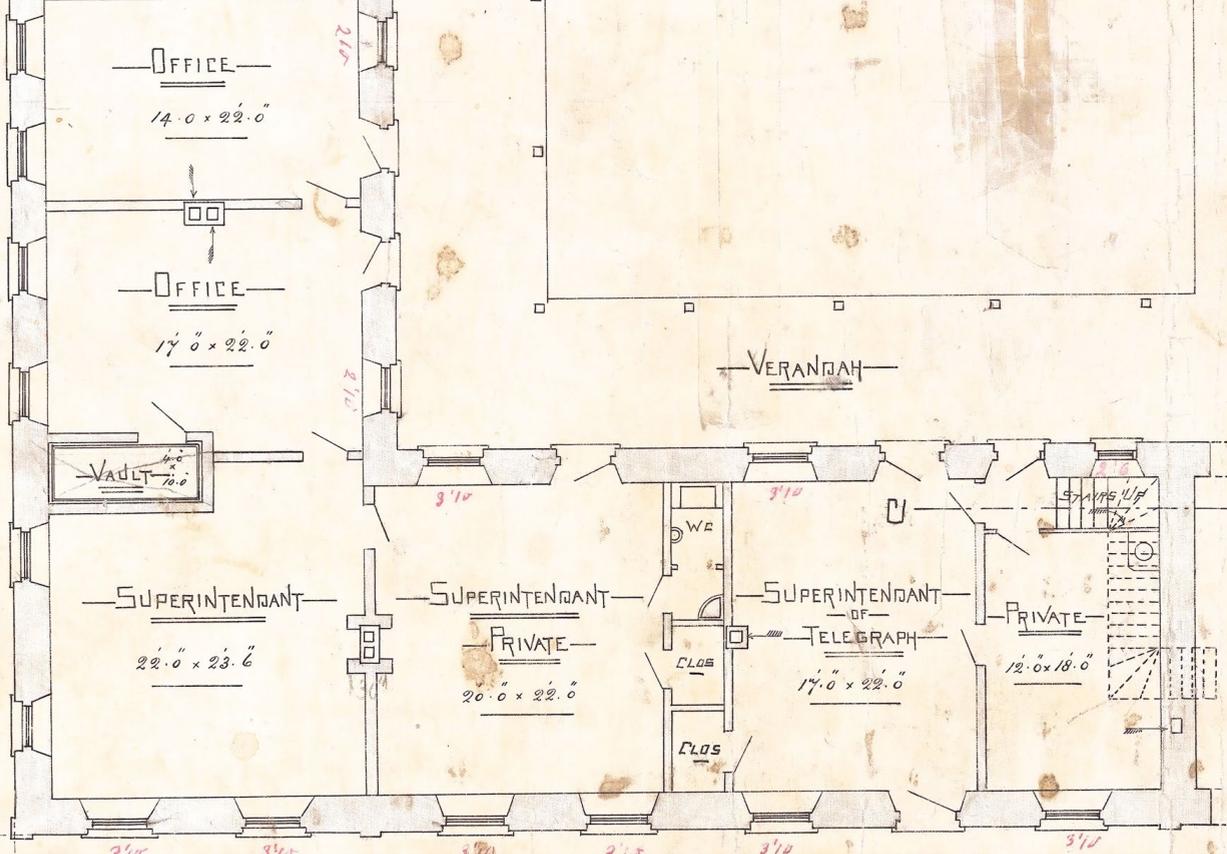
Detalle de planta arquitectónica de la estación del Ferrocarril Central Mexicano.
